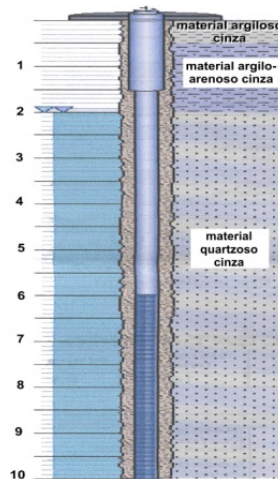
Perfil do piezômetro da Fazenda do Tuta
